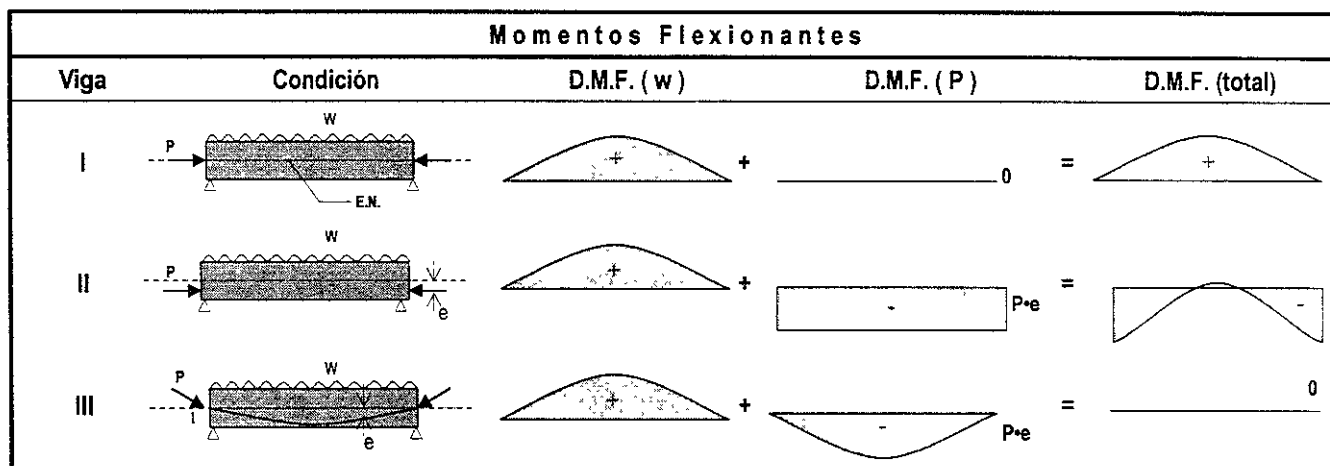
Momentos flexionantes a lo largo de vigas presforzadas simplemente apoyadas
